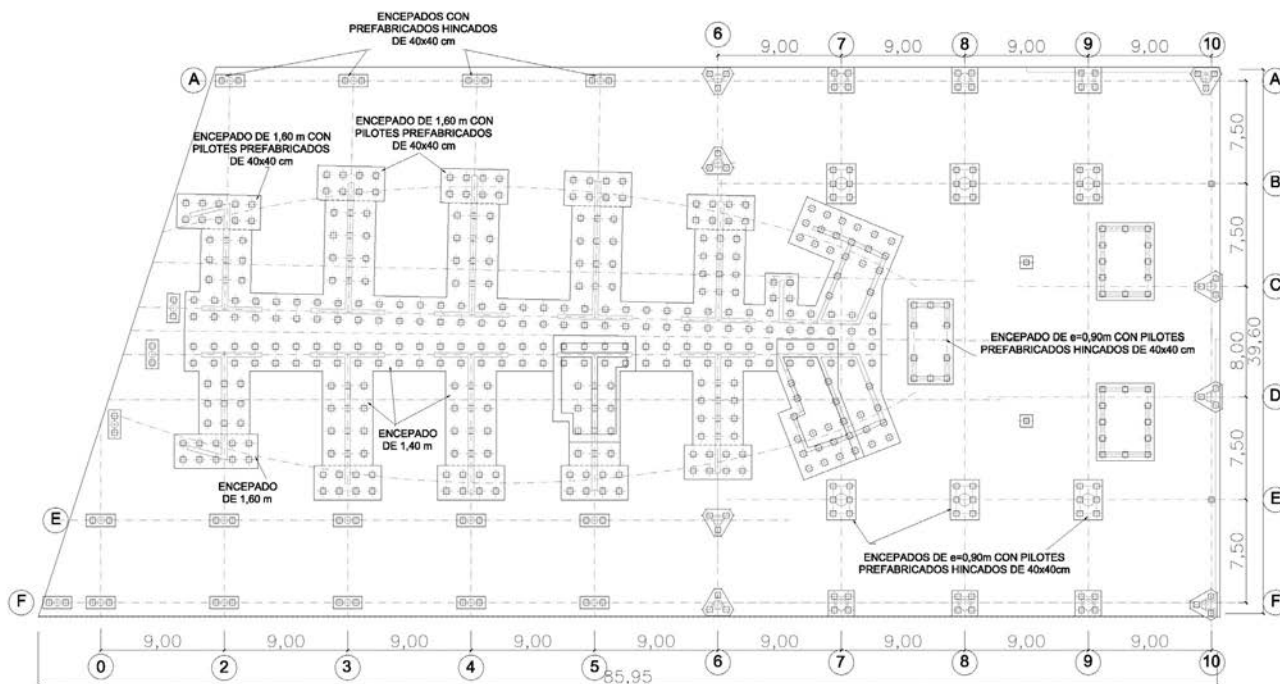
Planta de la cimentación de los edificios Torre y Atrio con pilotes prefabricados hincados.
